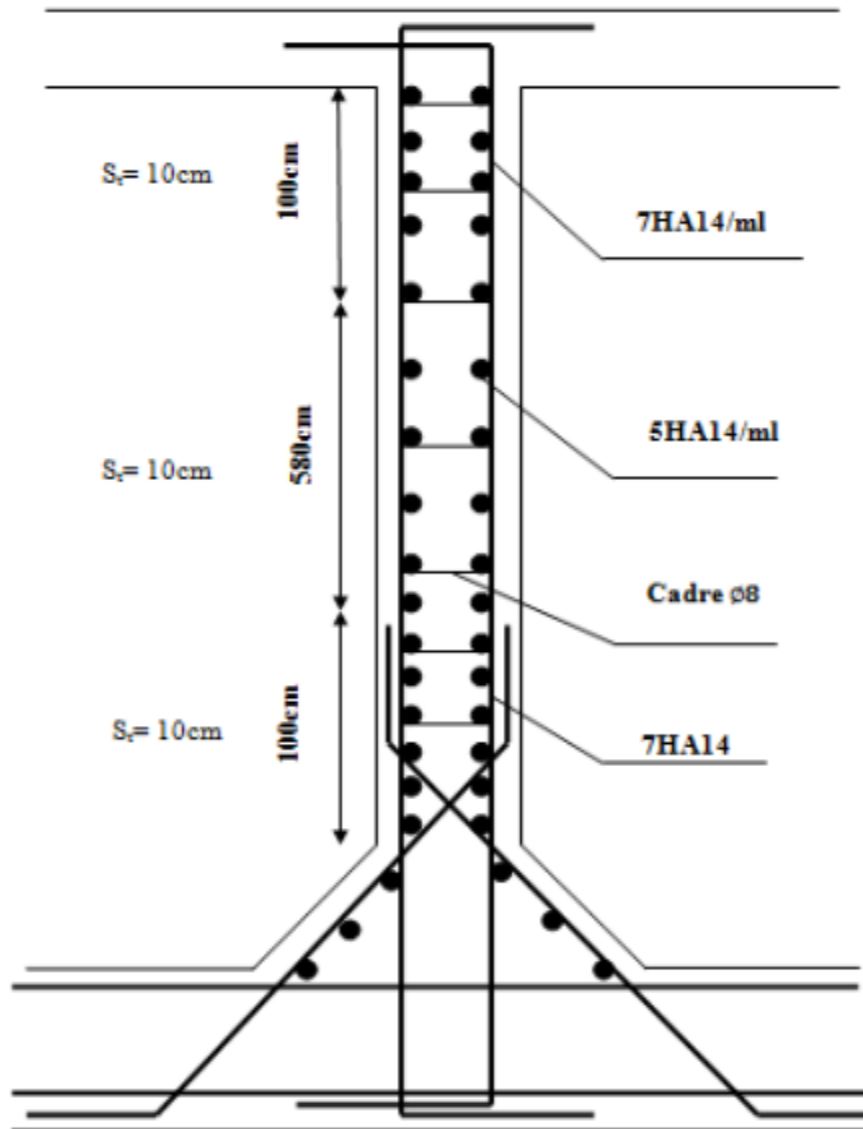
Ferrailage des voiles extérieurs en travée coupe (Z-Z').
